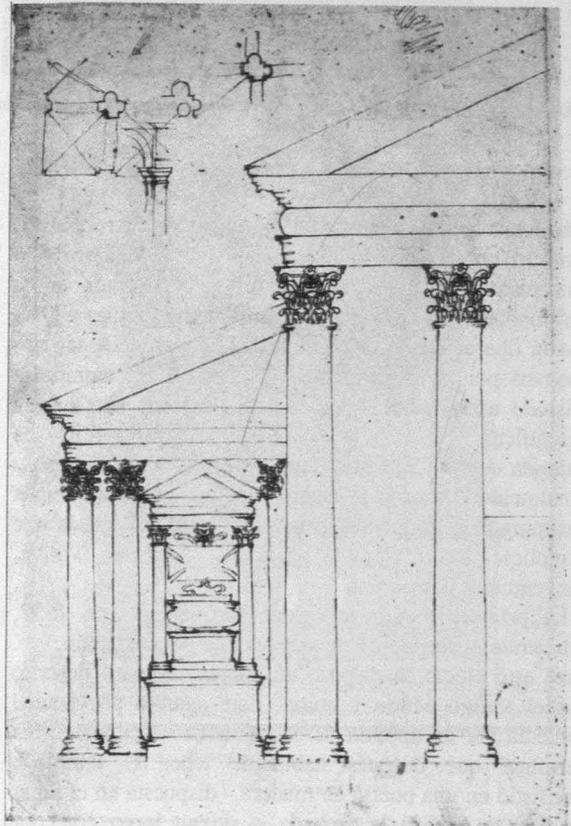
Supuesto proyecto de Palladio para la fachada de S. Giorgio.
